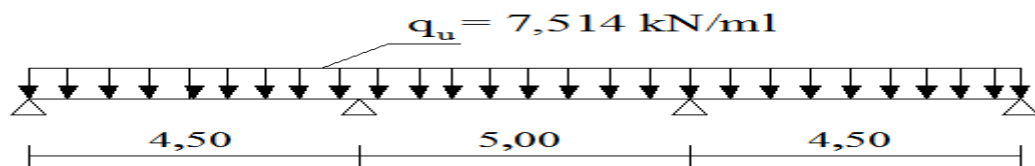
Diagramme des charges sur les poutrelles.
